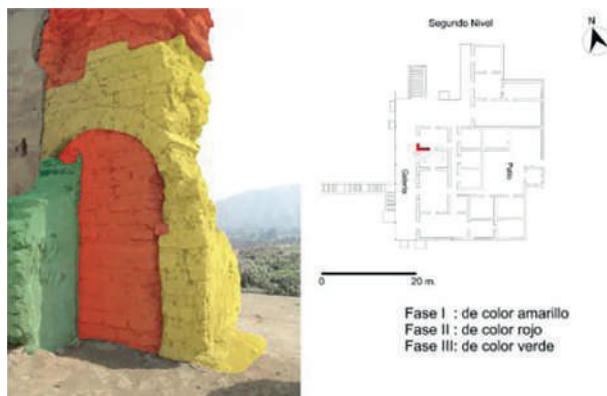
Secuencia constructiva de un muro en segundo nivel de la casa hacienda Caballero.
